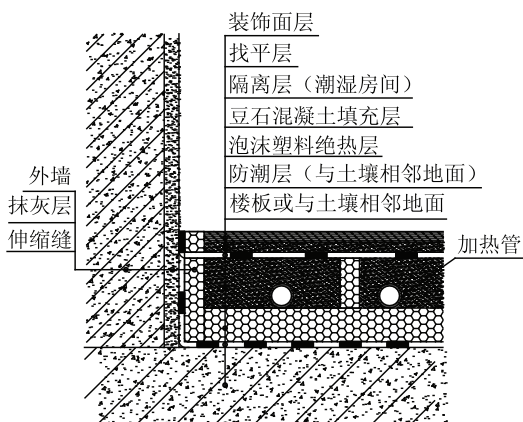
混凝土填充式热水供暖地面构造（一）
